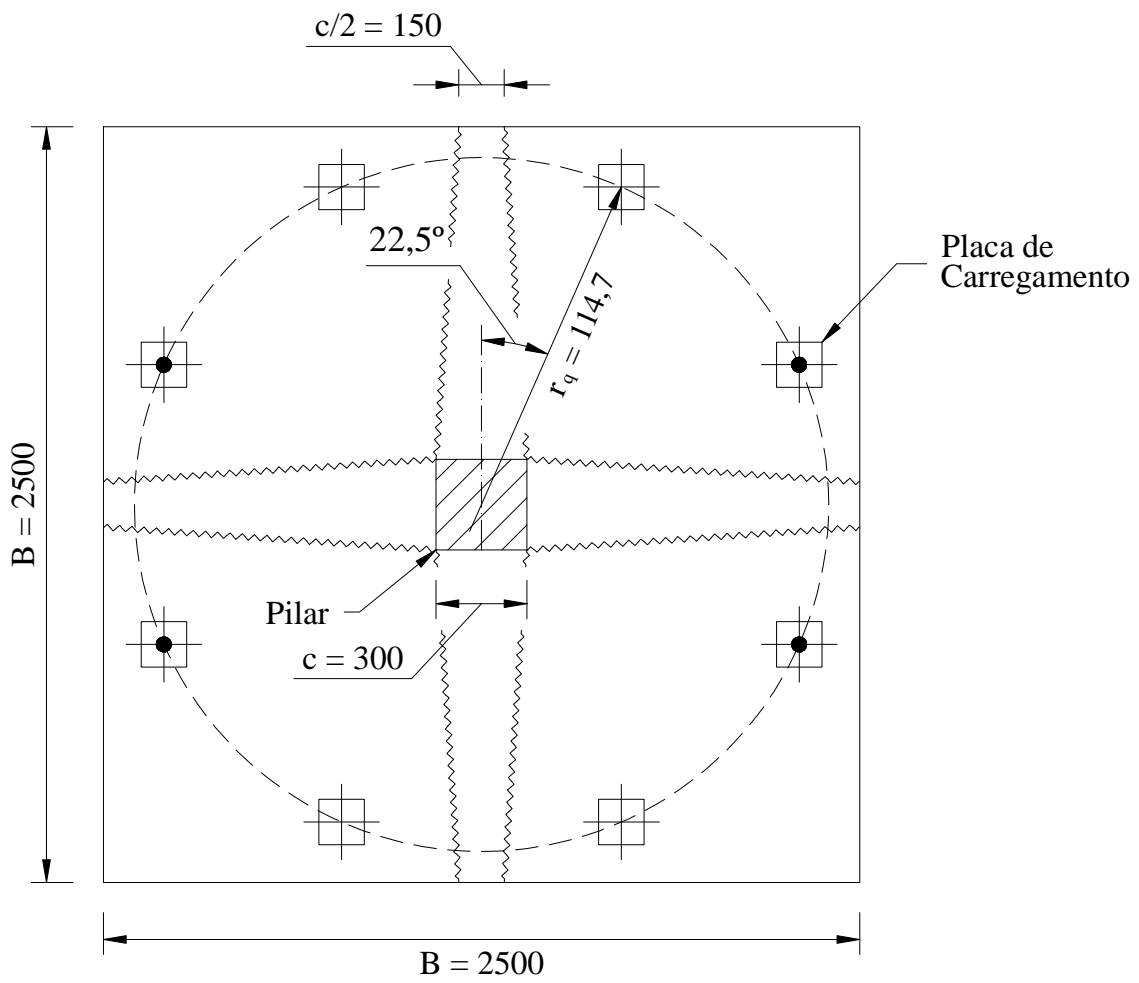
Linhas de rupturas adotadas para as lajes
